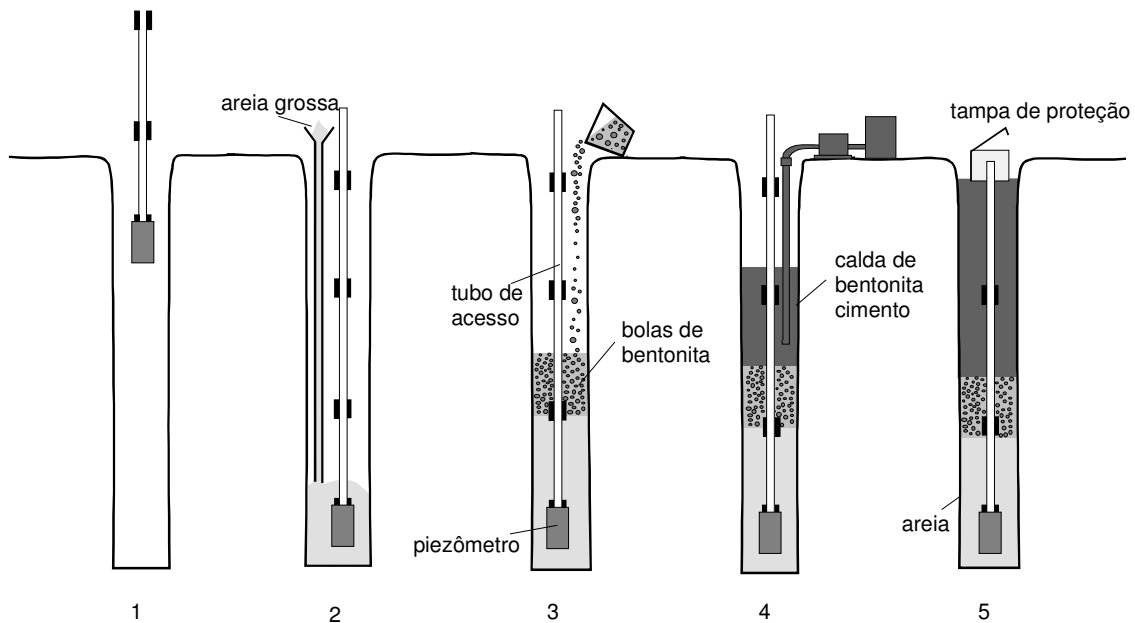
Fases de instalação de um piezômetro Casagrande (GEORIO, 2000).
